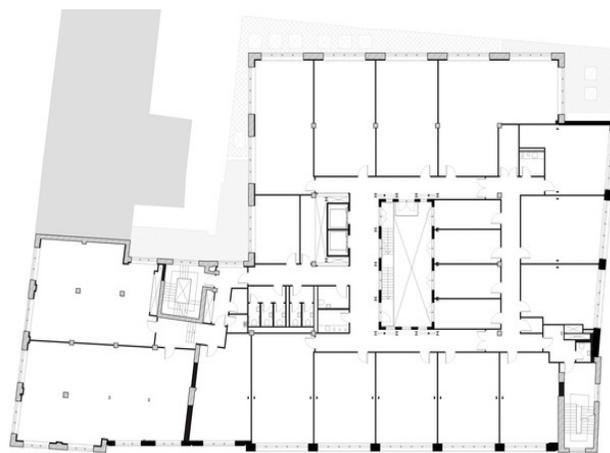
Pianta tipo, organizzazione spaziale interna.
